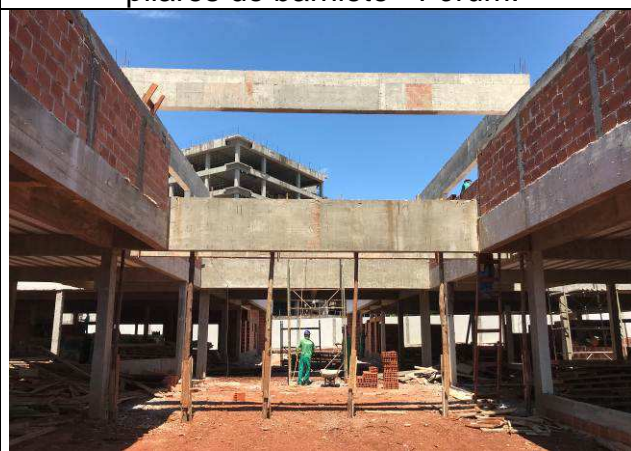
C: Vigas e pilares do barrilete concretados - Fórum.
